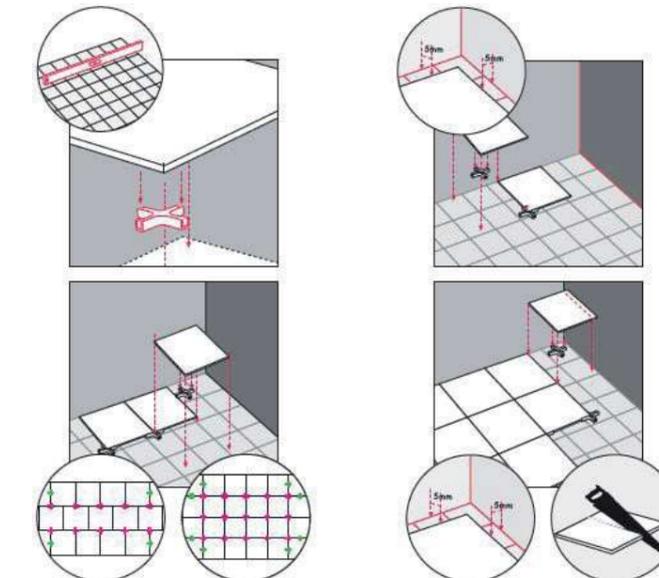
Esquema de montaje UPM ProFi Floor Tile.
